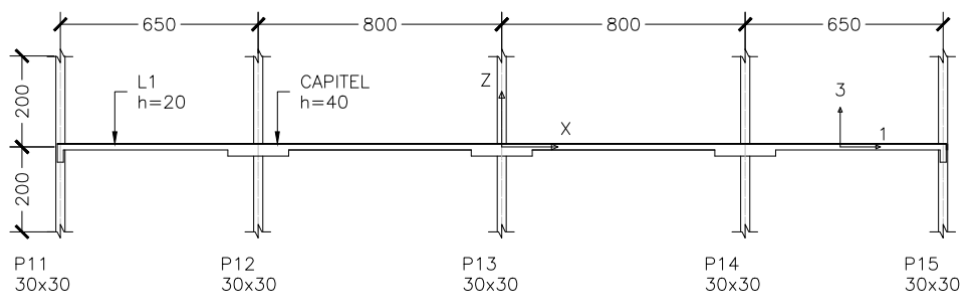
Corte transversal da laje com eixos globais e locais de referência (dimensões em cm).
